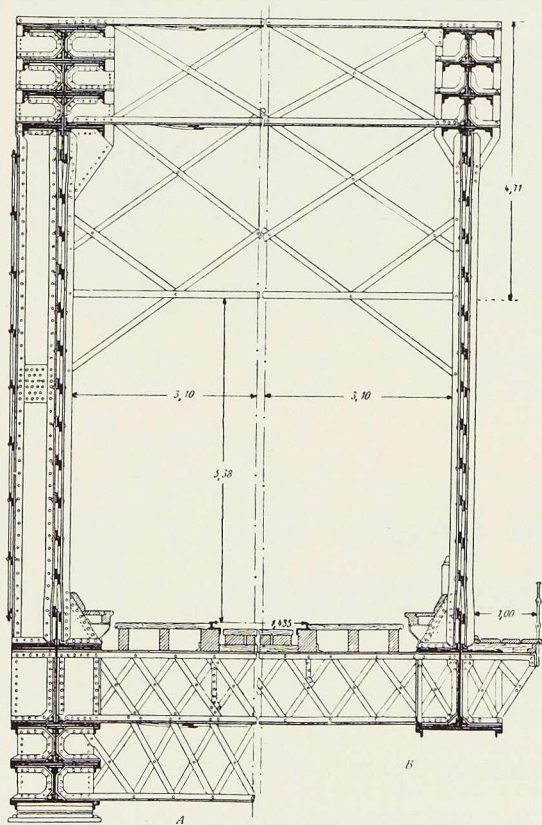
Coupe transversale du pont-rails sur la Vistule près de Dirschau.
